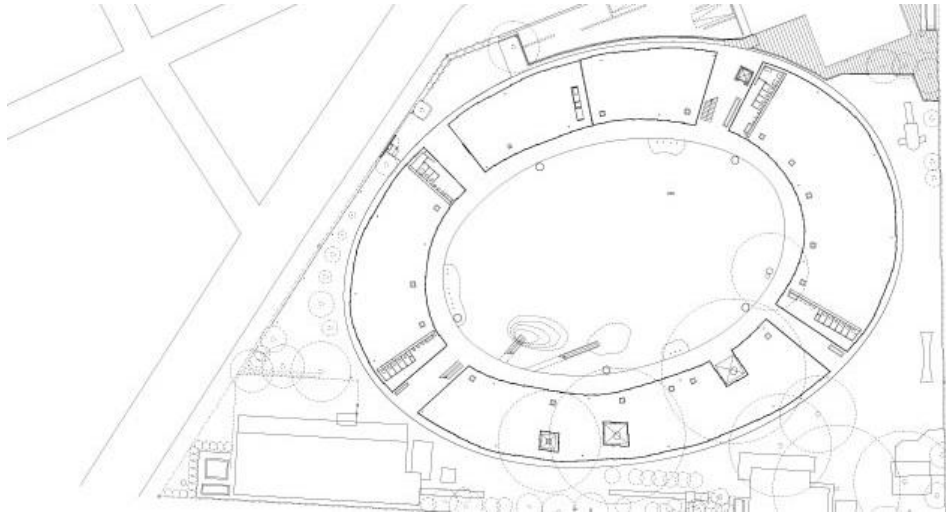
Planta baixa das salas de aula (ambientes sem paredes).
